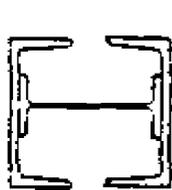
, 24e y 24f: Cargas elevadas con alojamiento de bajantes e instalaciones.
